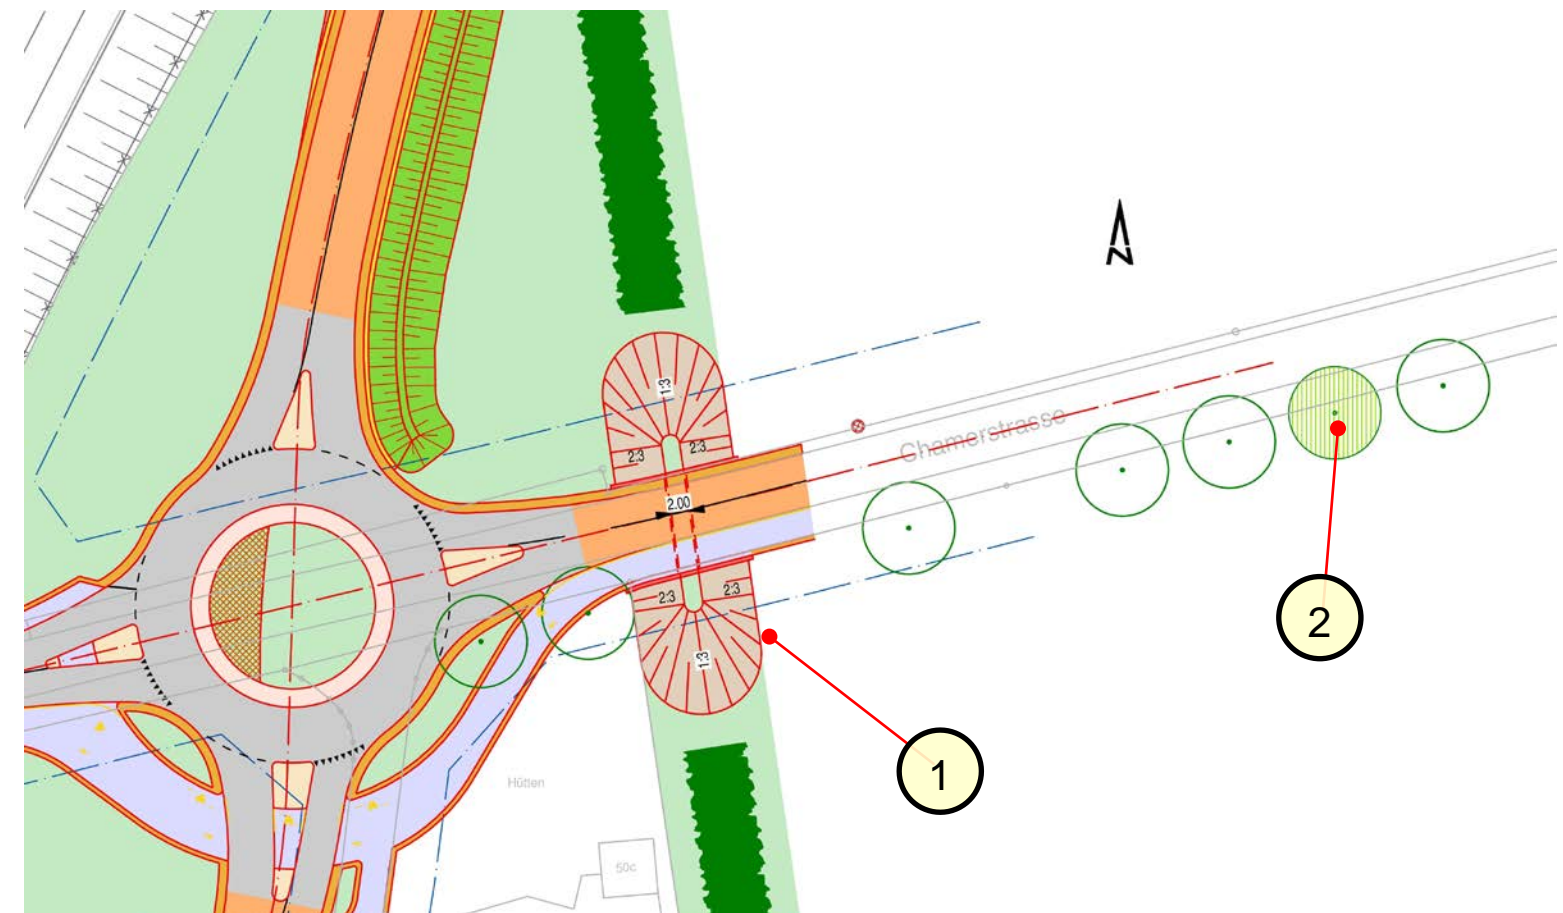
neuer Kleintierdurchlass Schlatt, Ersatz wegfallender Baum
